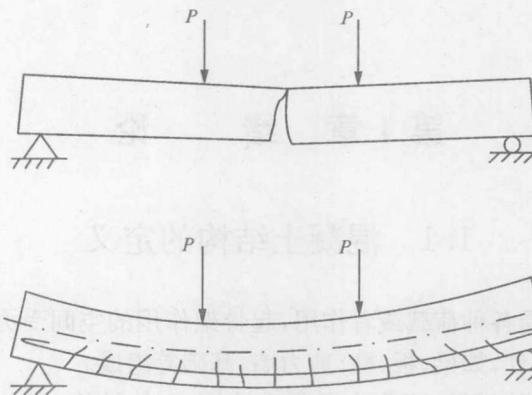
素混凝土梁与钢筋混凝土梁受力示意图
